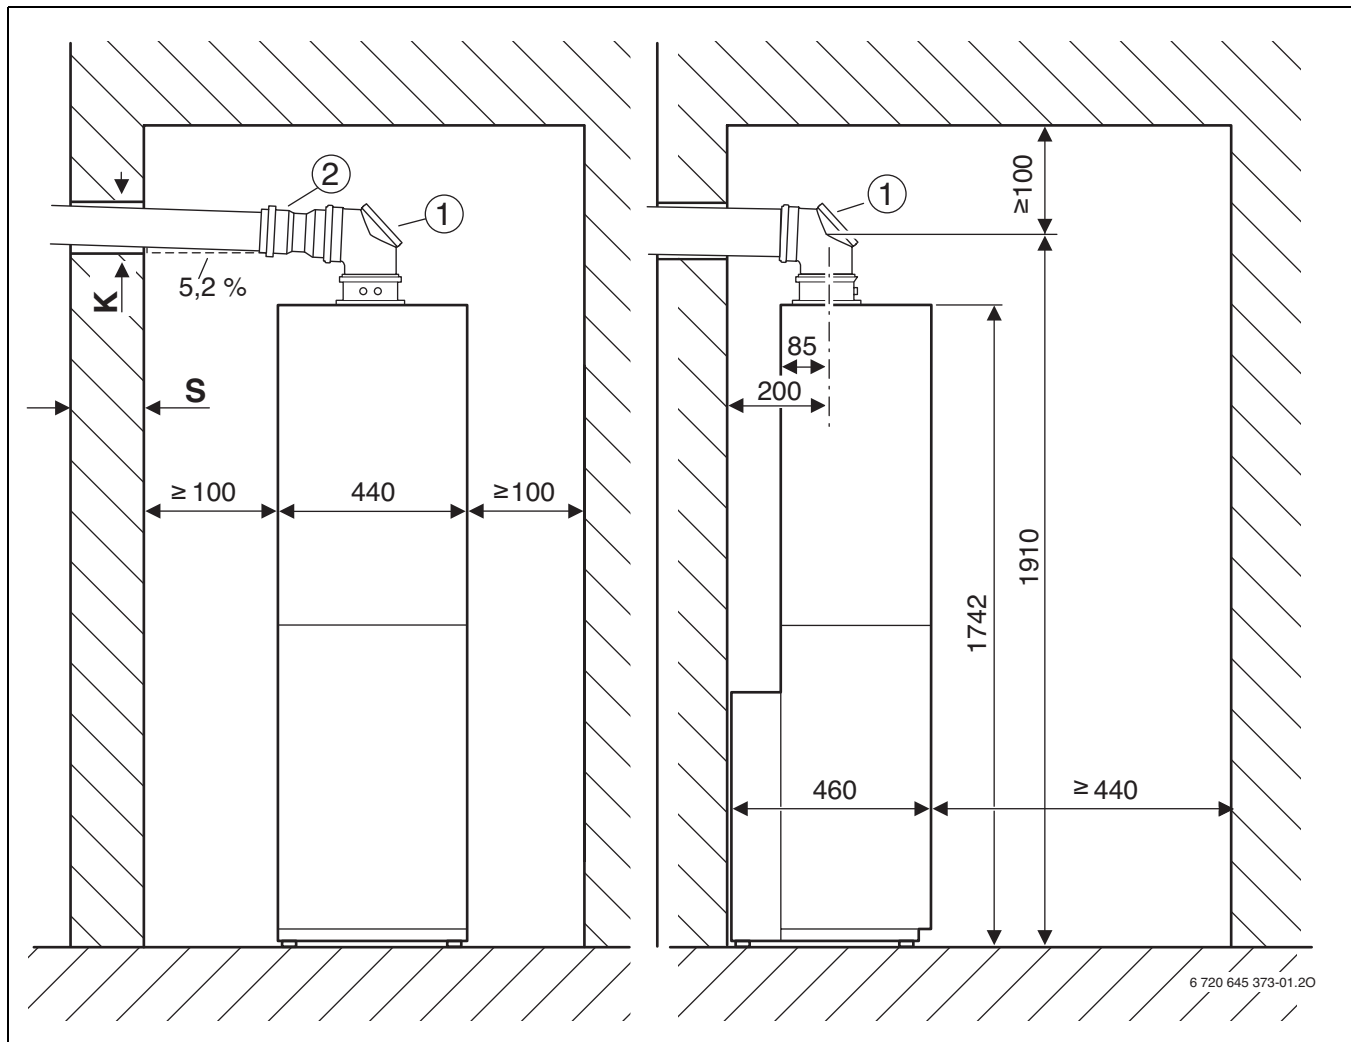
Abgasführung Ø 80/125 mm, Ø 80 mm oder Ø 60/100 mm
